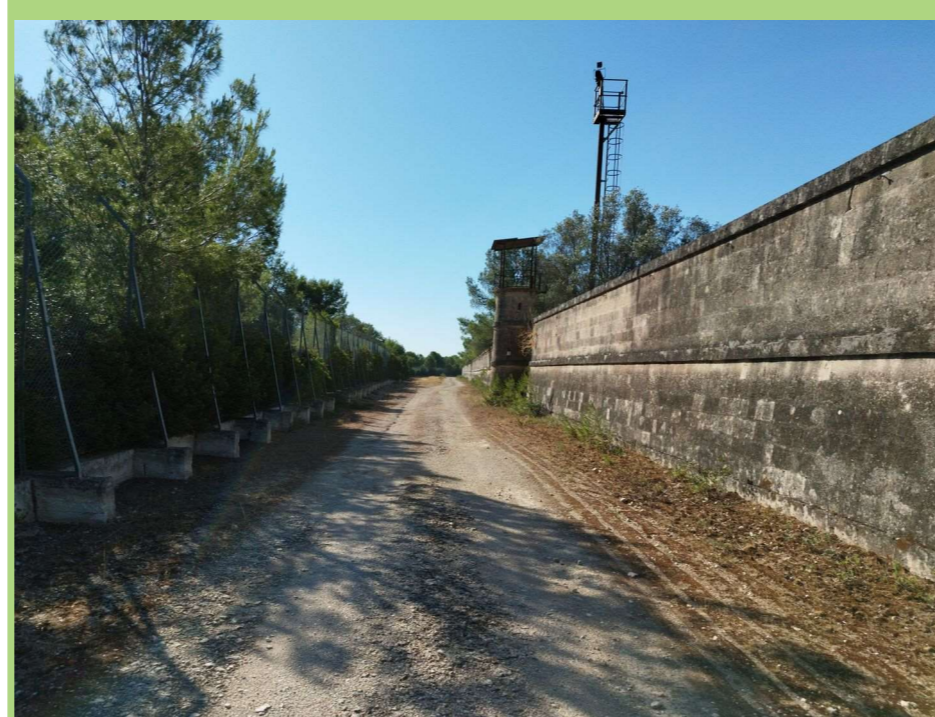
Torretta di avvistamento e muro perimetrale della ex-polveriera.
